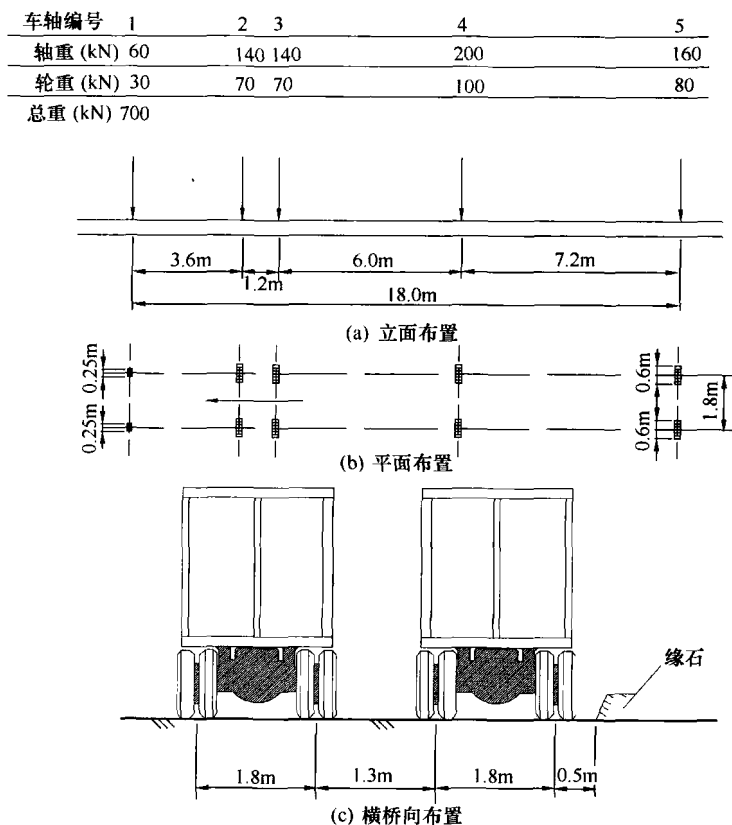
城—A级车辆荷载立面、平面、横桥向布置
